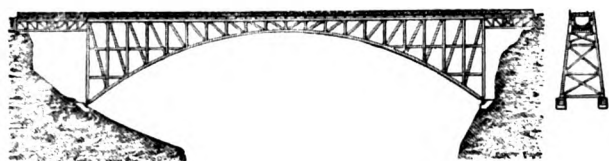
e 17. — Ponte sullo Zambese. Elevatione e sezione.
